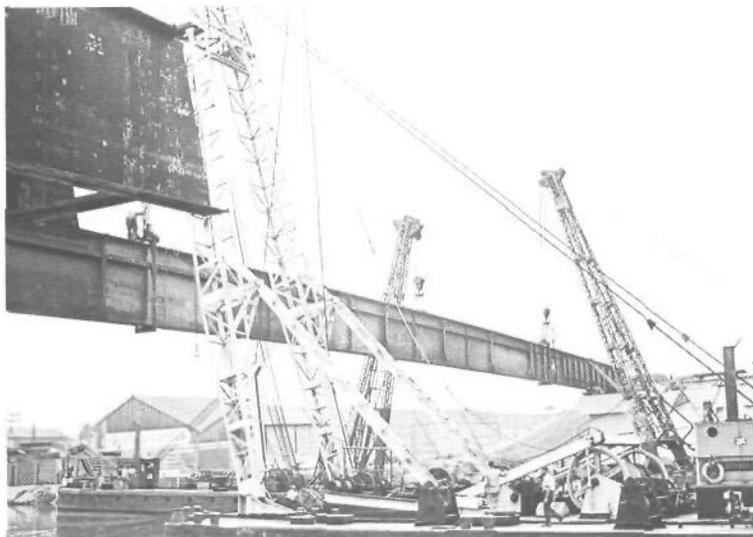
Mise en place d'un tronçon central de poutre en I. La stabilité est assurée par la bigue centrale.
